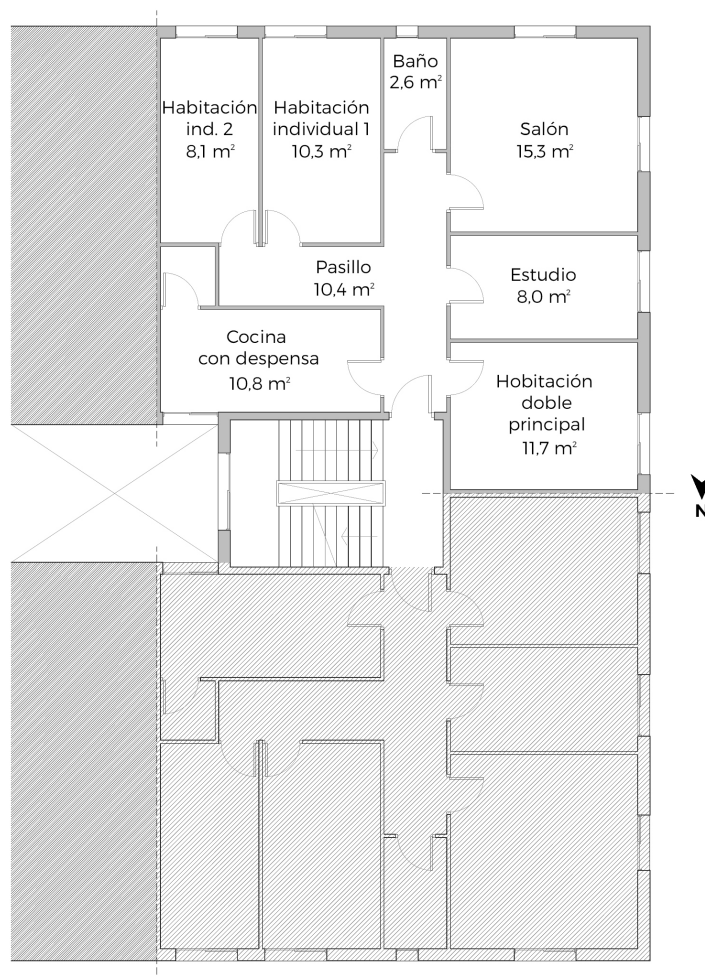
Vivienda en edificio residencial: distribución de espacios interiores y dimensiones (m<sup>2</sup>). Primera planta, cota + 3,65 m.
